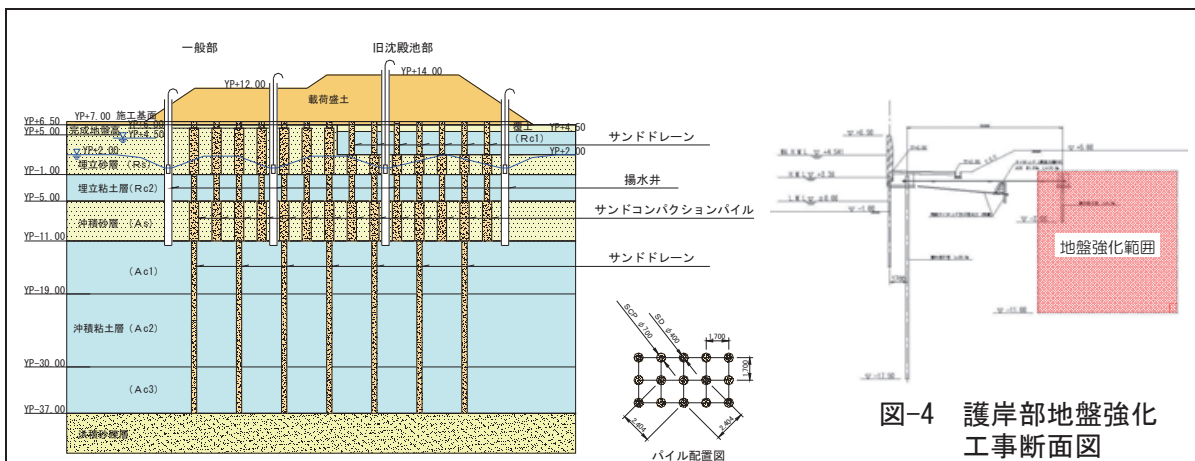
No. 5, 6LNG タンク部地盤強化工事断面図
